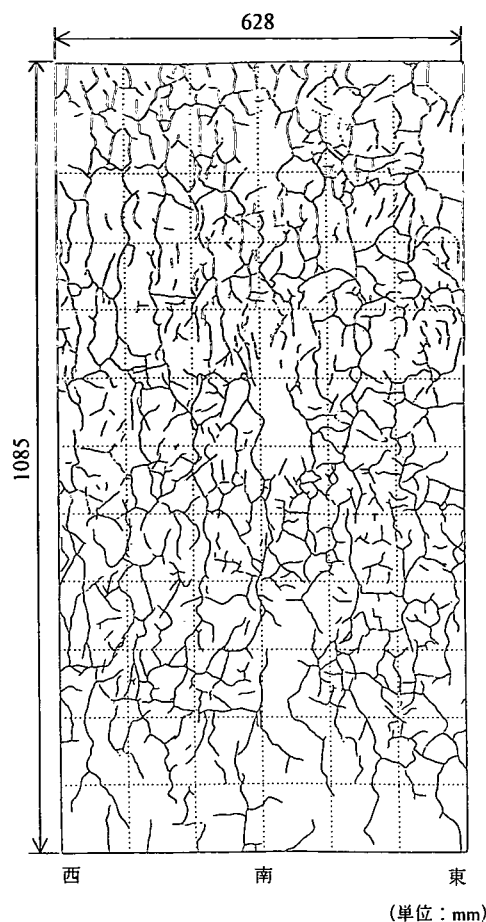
ひび割れ発生状況 (A2 試験体, 南側)
